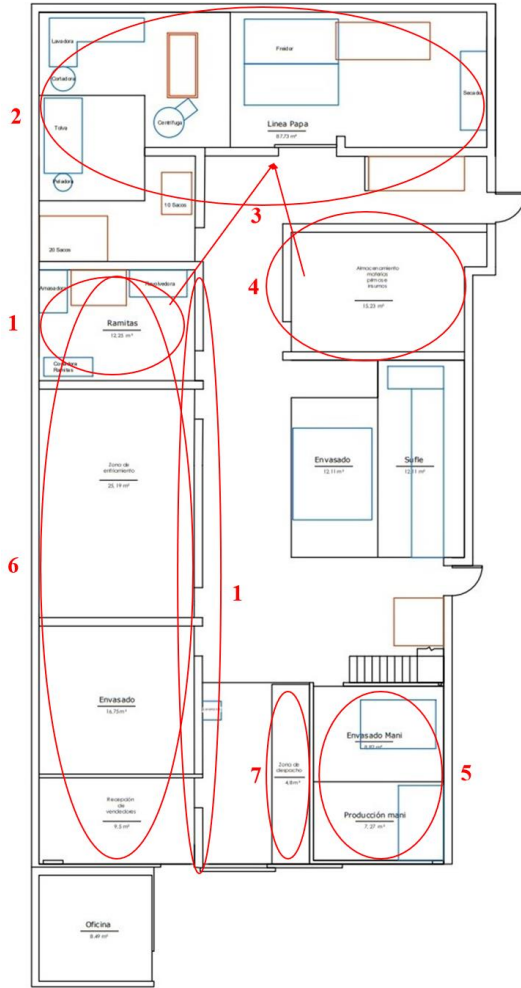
Layout propuesta B en formato AutoCAD.
